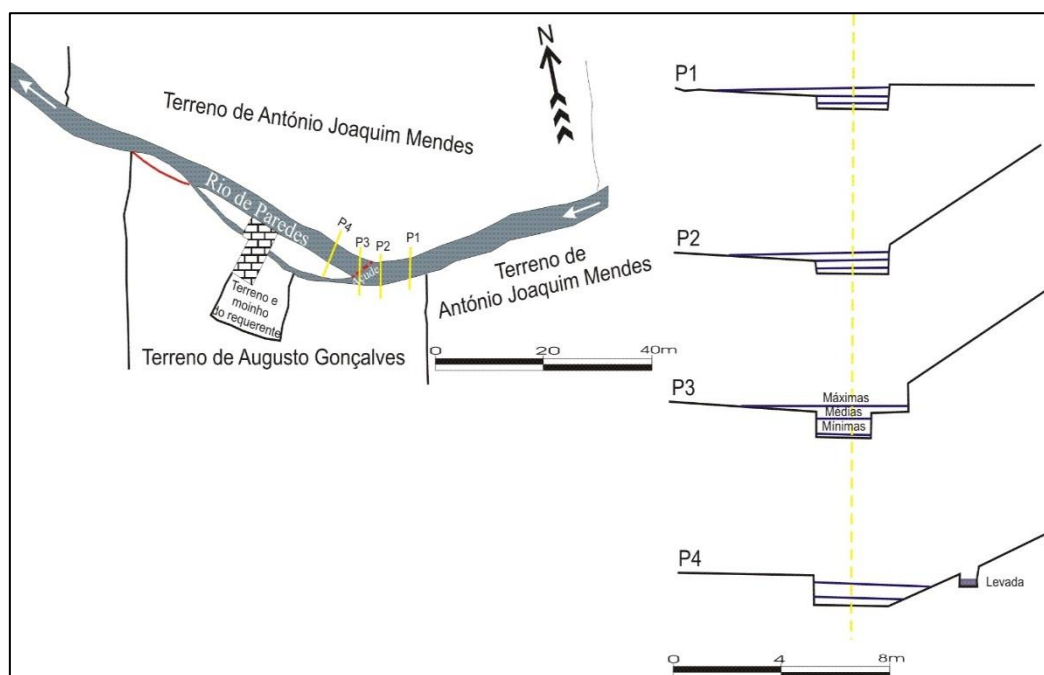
Planta e cortes relativos ao processo para construir açude de irrigação, no rio Ferro (Fraga, Armil, Fafe, 1903). Fonte: adaptado de APA.
